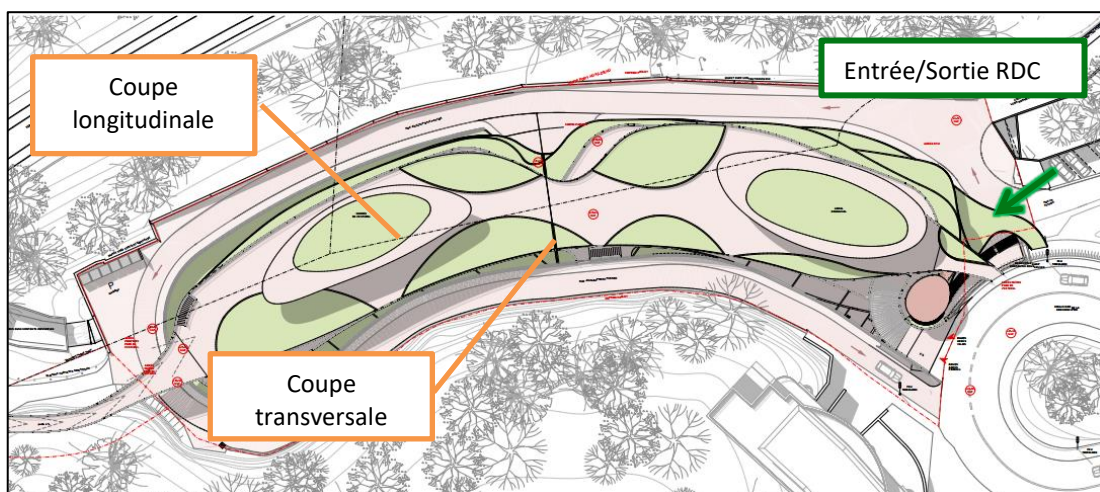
Plan des aménagements paysagers : vue toiture (Source : Atelier du Pont, 2021)
